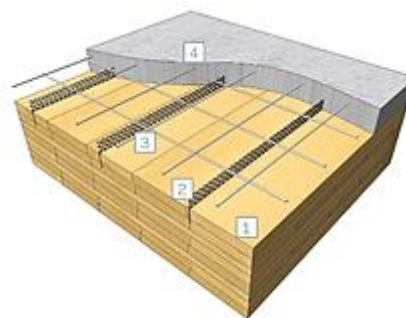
Система HBV: 1 – CLT панель; 2 – стальная сетка HBV; 3 – арматурная сетка бетонной заливки; 4 – бетон
